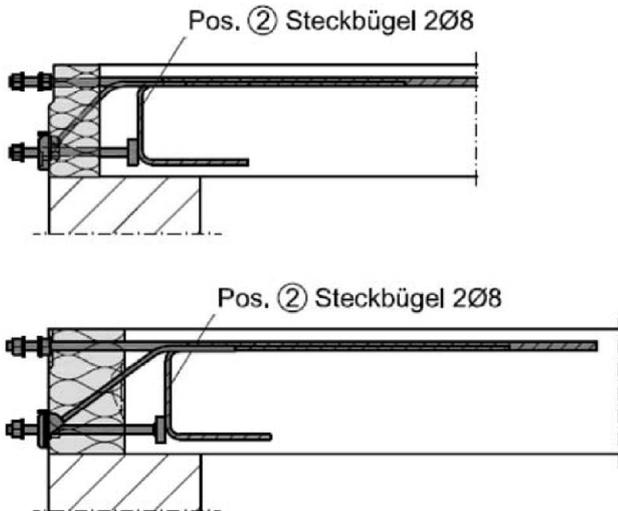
Seitenansicht: Schöck Isokorb® T Typ SK-M1-V1, T Typ SK-M1-V2 und
